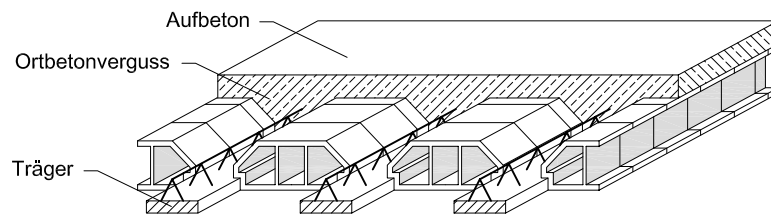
Aufbau einer Füllkörperdecke [34]
